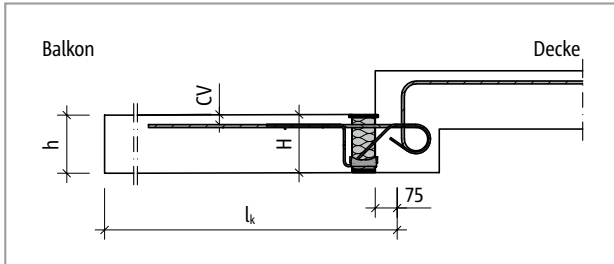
Schöck Isokorb® T Typ K-HV: Statisches System
